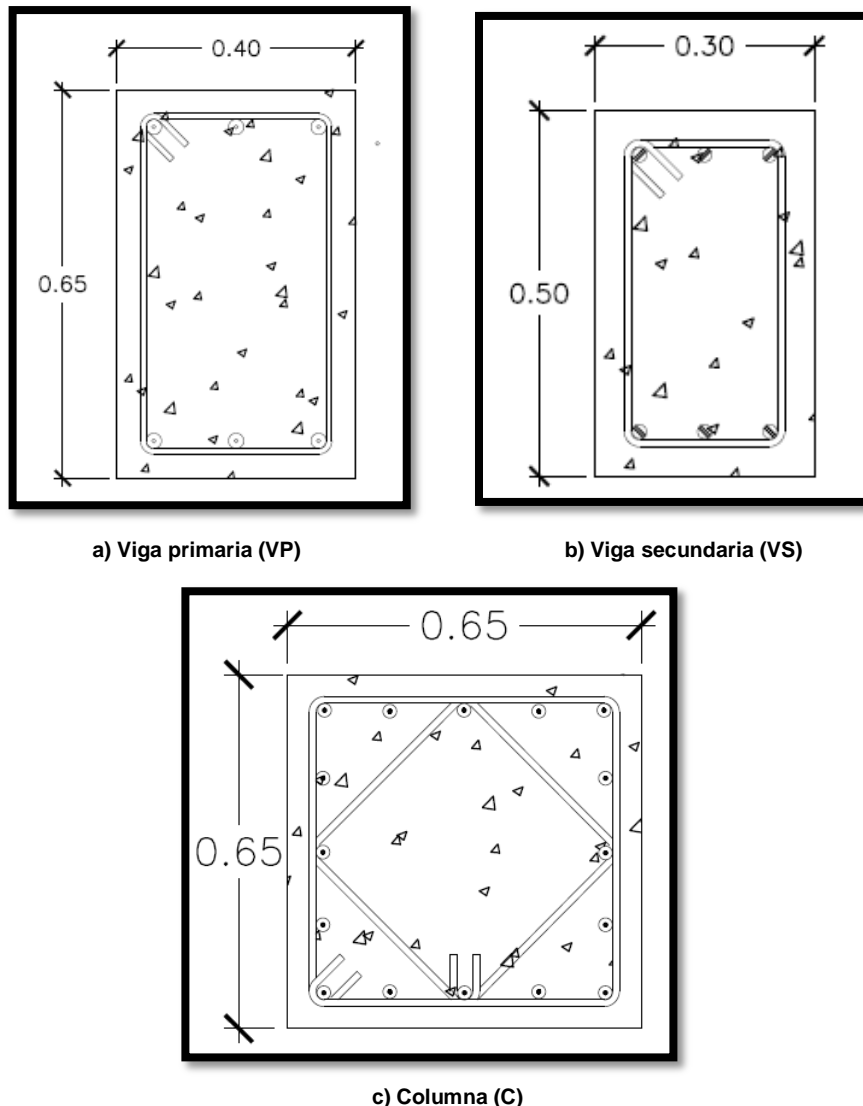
Sección de viga primaria, secundaria y columnas las cuales serán usadas en el diseño.
